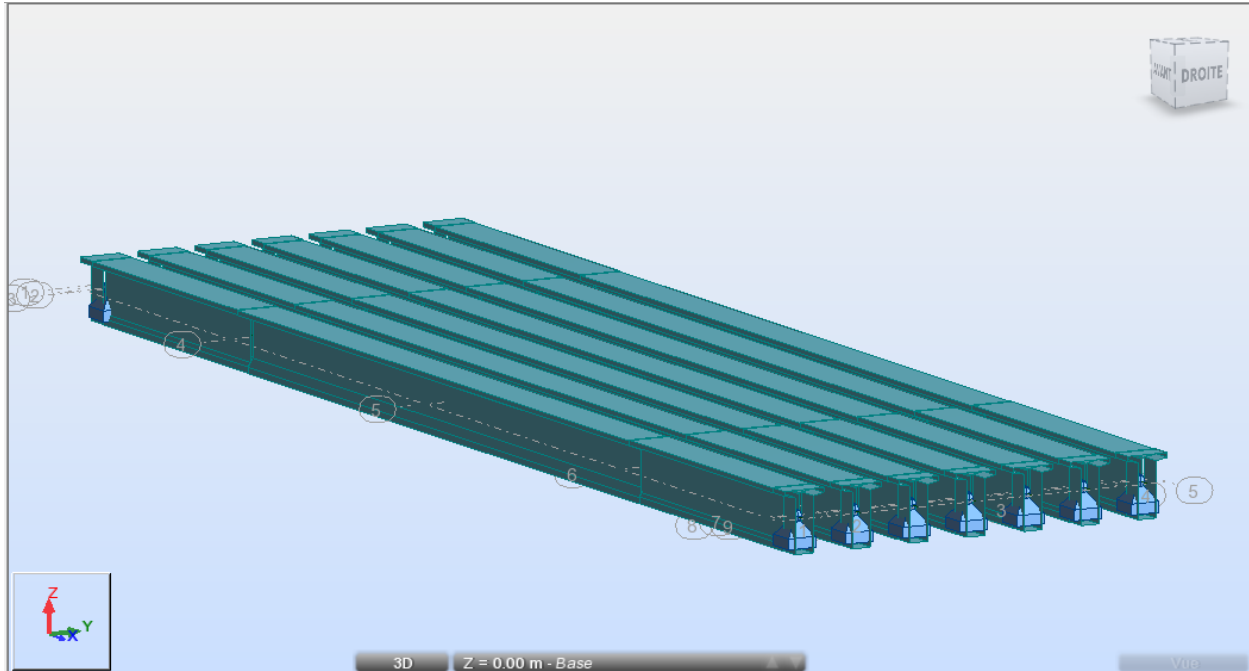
Les poutres en vue 3D avec les appuis.
